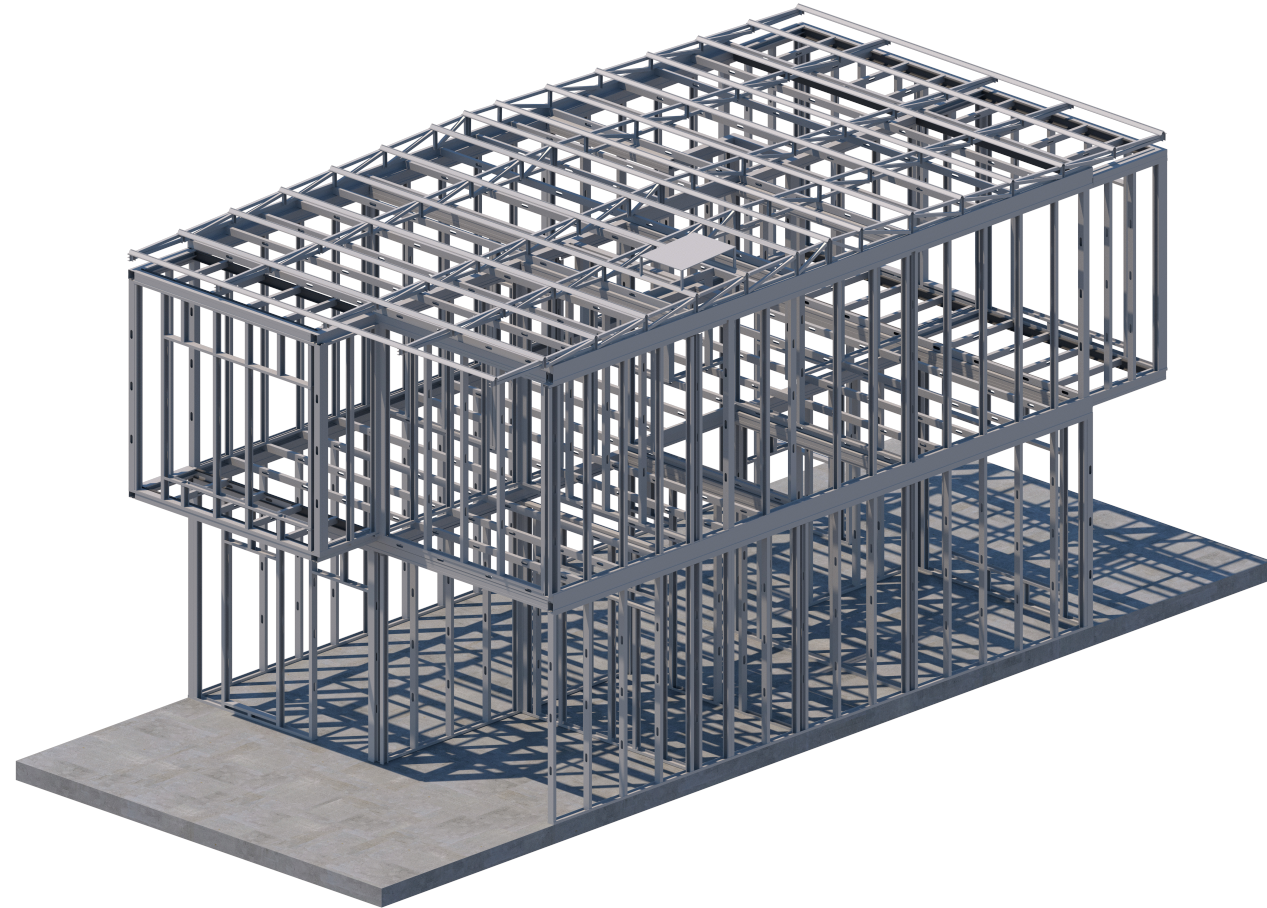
Modelado detalle constructivo 4 entramado entrepiso
